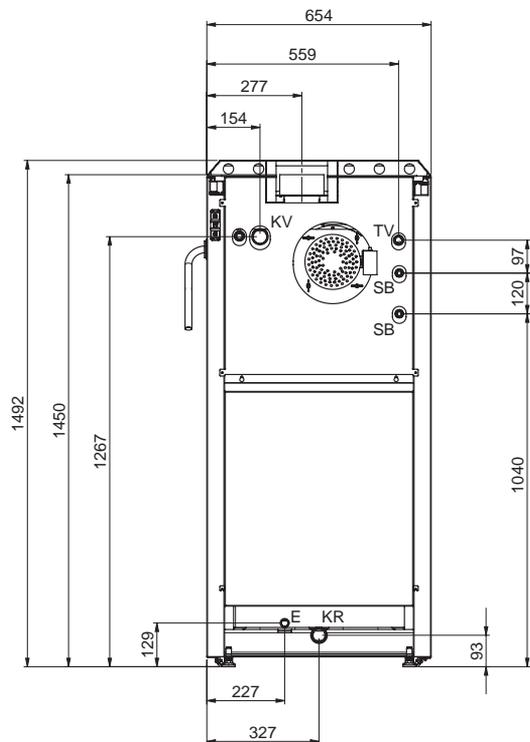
Ventilatore gas combusti direttamente sulla caldaia – vista da dietro
